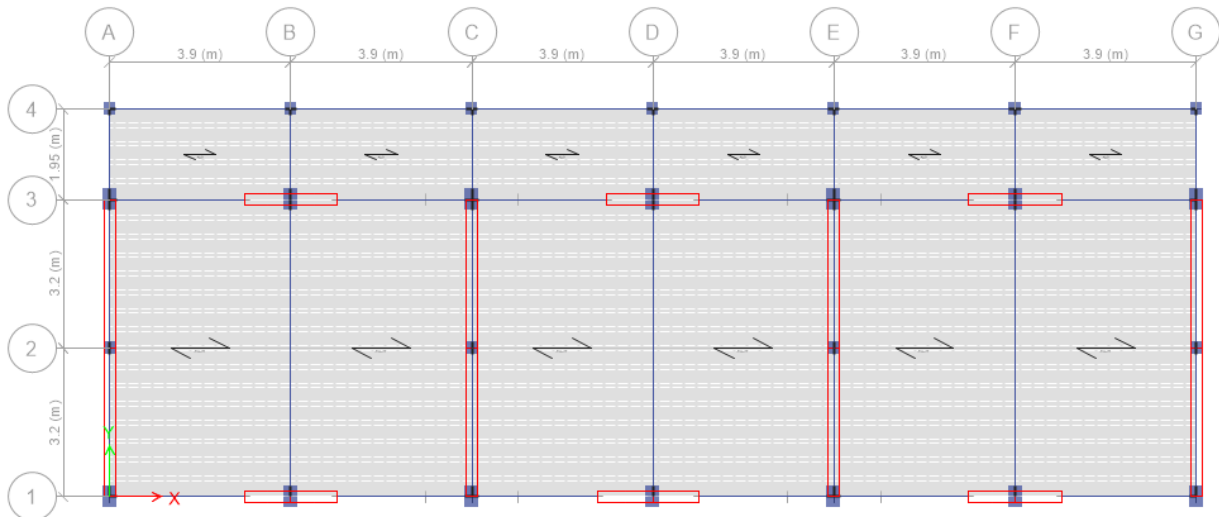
Vista en planta del pabellón 3 con placas de concreto armado.
